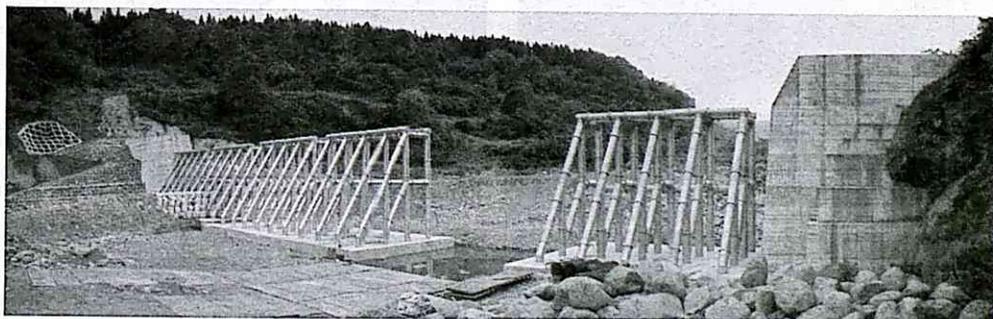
鋼製の格子型スリットダムの施工例（矢代川砂防堰堤）
